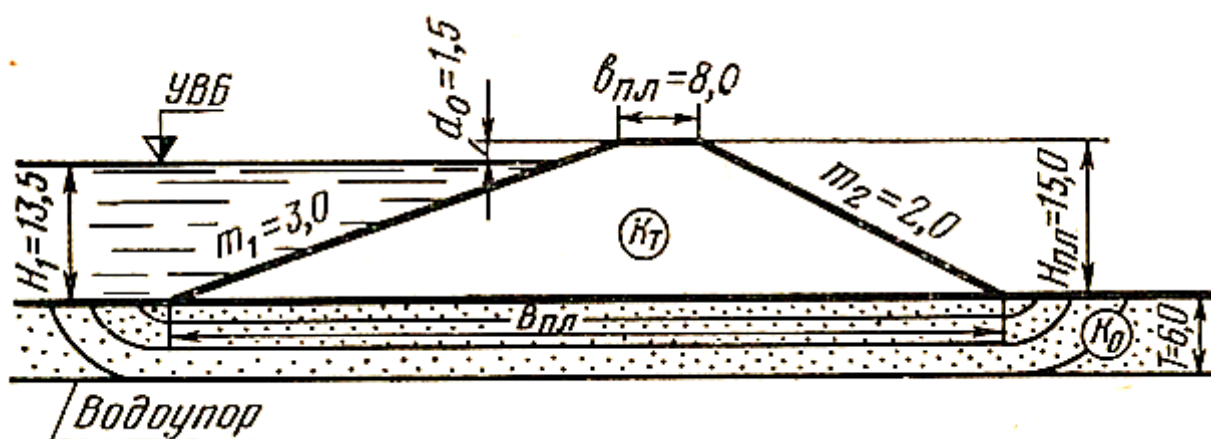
Расчетная схема фильтрации через однородную земляную плотину на водопроницаемом основании конечной глубины без дренажа при отсутствии воды в нижнем бьефе по способу акад. Н.Н. Павловского
